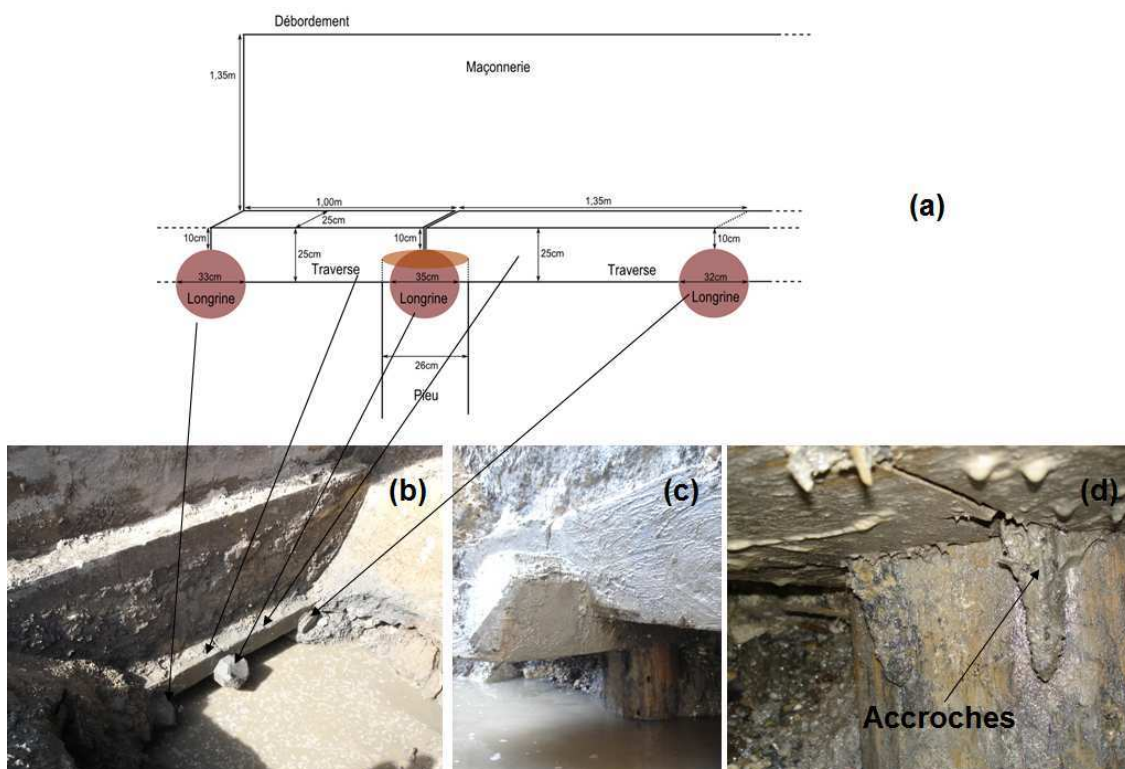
Vue de face de la fondation (a) et photos prises sur sites (b, c et d)
